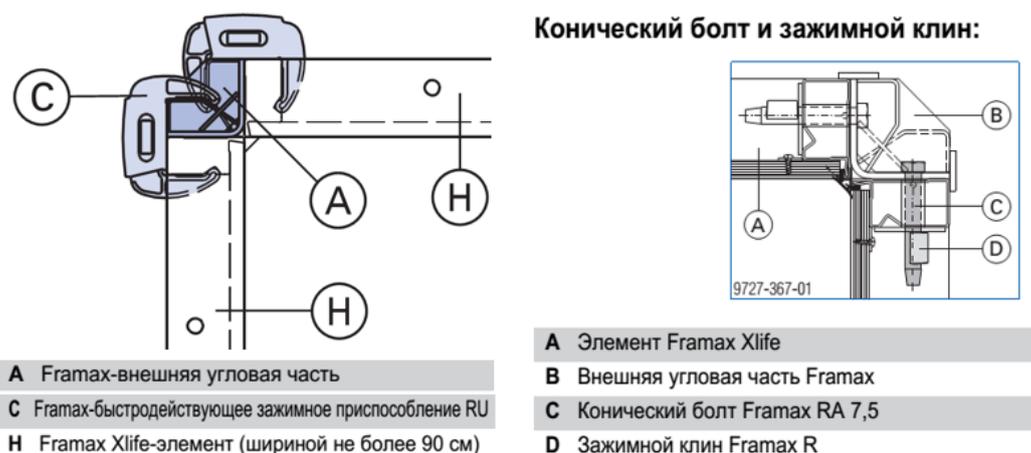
Конструктивные приемы формирования углов и торцов (опалубки FRAMAX): прямой угол с использованием целых щитов и инвентарных элементов креплений внешних углов (вверху); угловые соединения с использованием универсальных щитов при сборке опалубки в «мельницу» (внизу) (начало)
